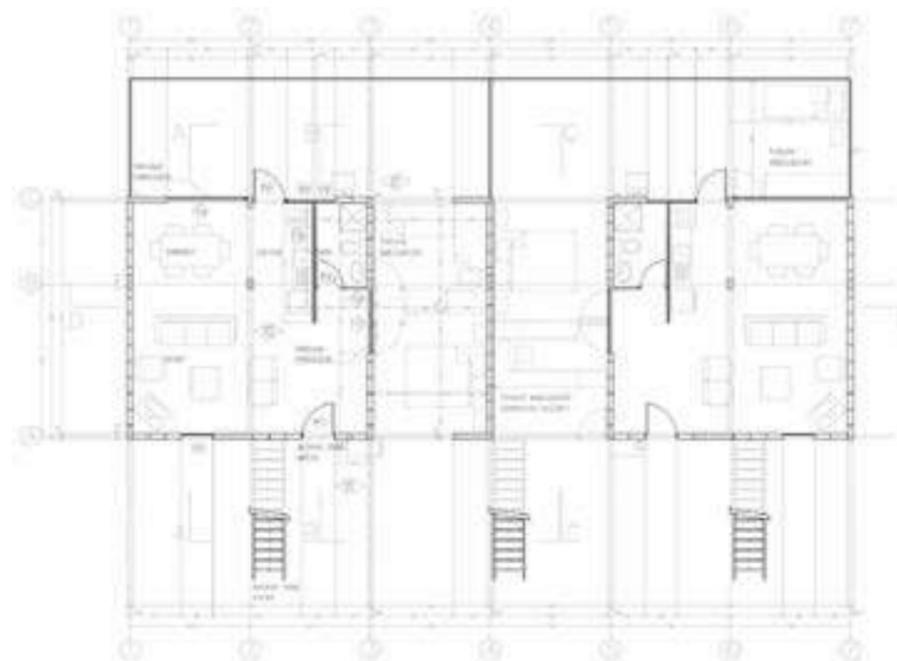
Quinta Monroy Planta Térreo. Fonte. Archdaily/ELEMENTAL
